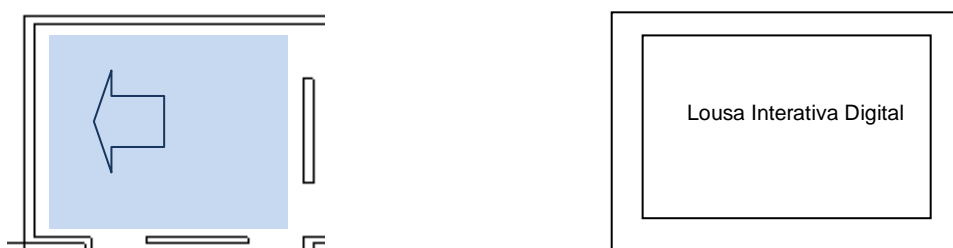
Módulo Contexto Urbano. Planta baixa e elevação esquemática da parede 02.
